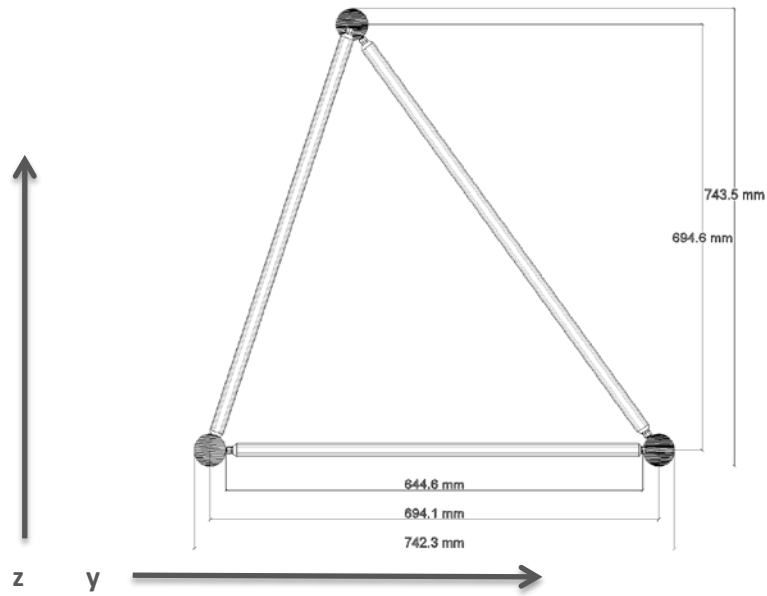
Vista en alzado (eje y) del núcleo tetraédrico con las dimensiones establecidas para el proyecto, según el cálculo de barras de 50 cm de longitud.
